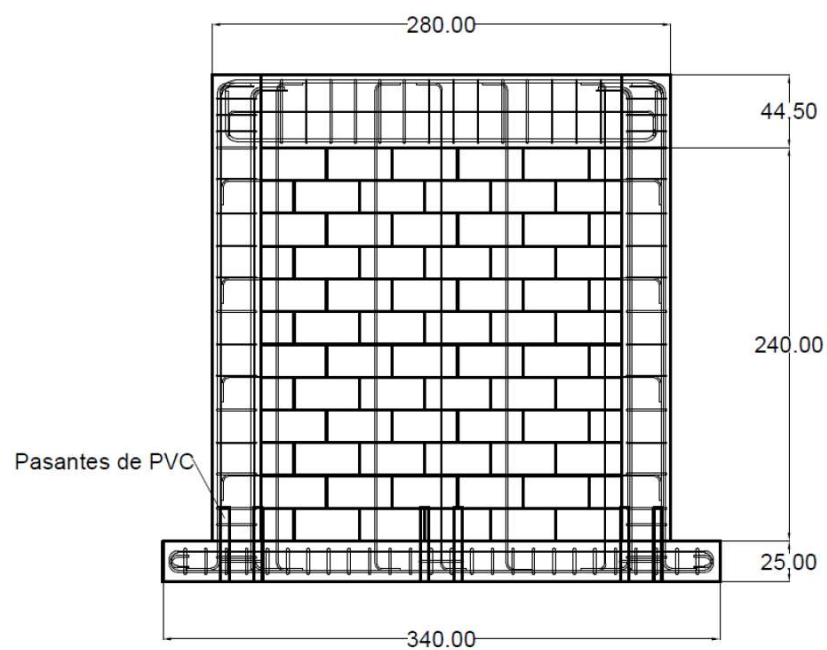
Vista lateral del muro con $h/l = 1$ y fundación tipo 1 (cotas en cm).
